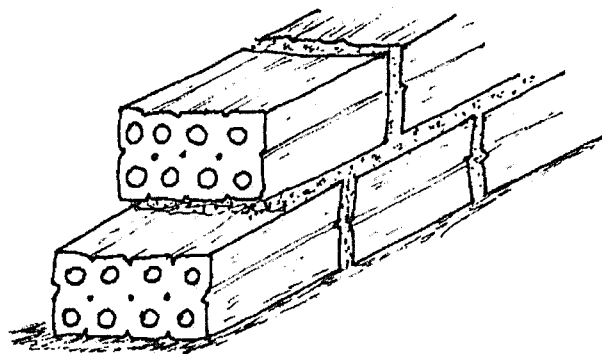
Execução de alvenaria de 1 vez, utilizando tijolos furados.
